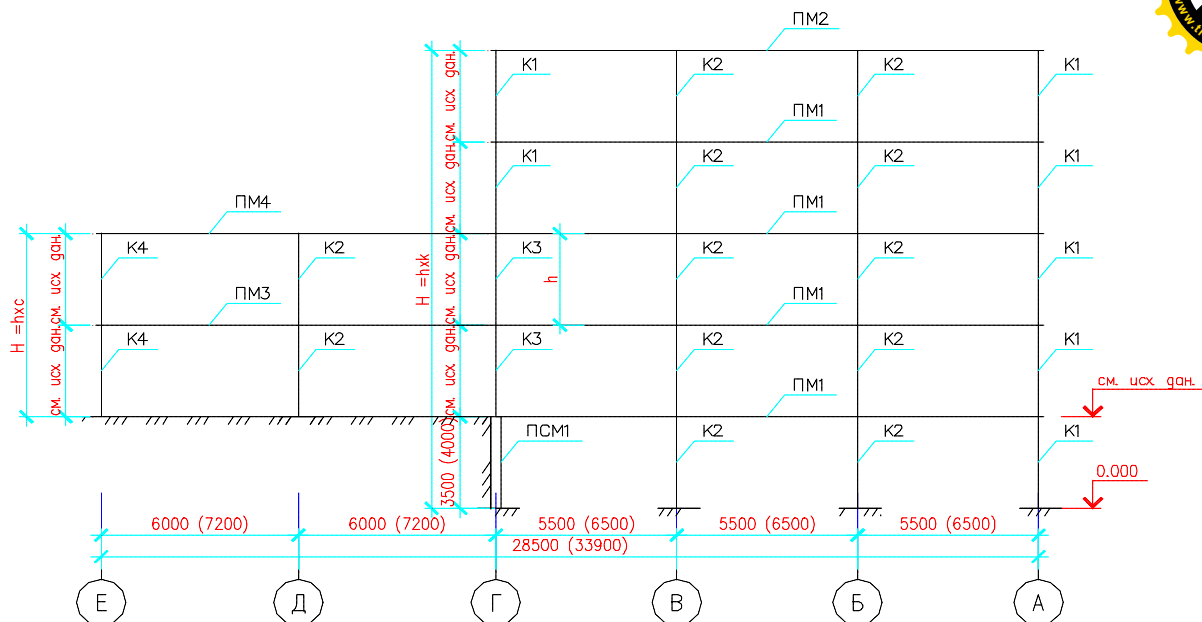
Поперечный разрез (силовая рама) железобетонного каркаса.
